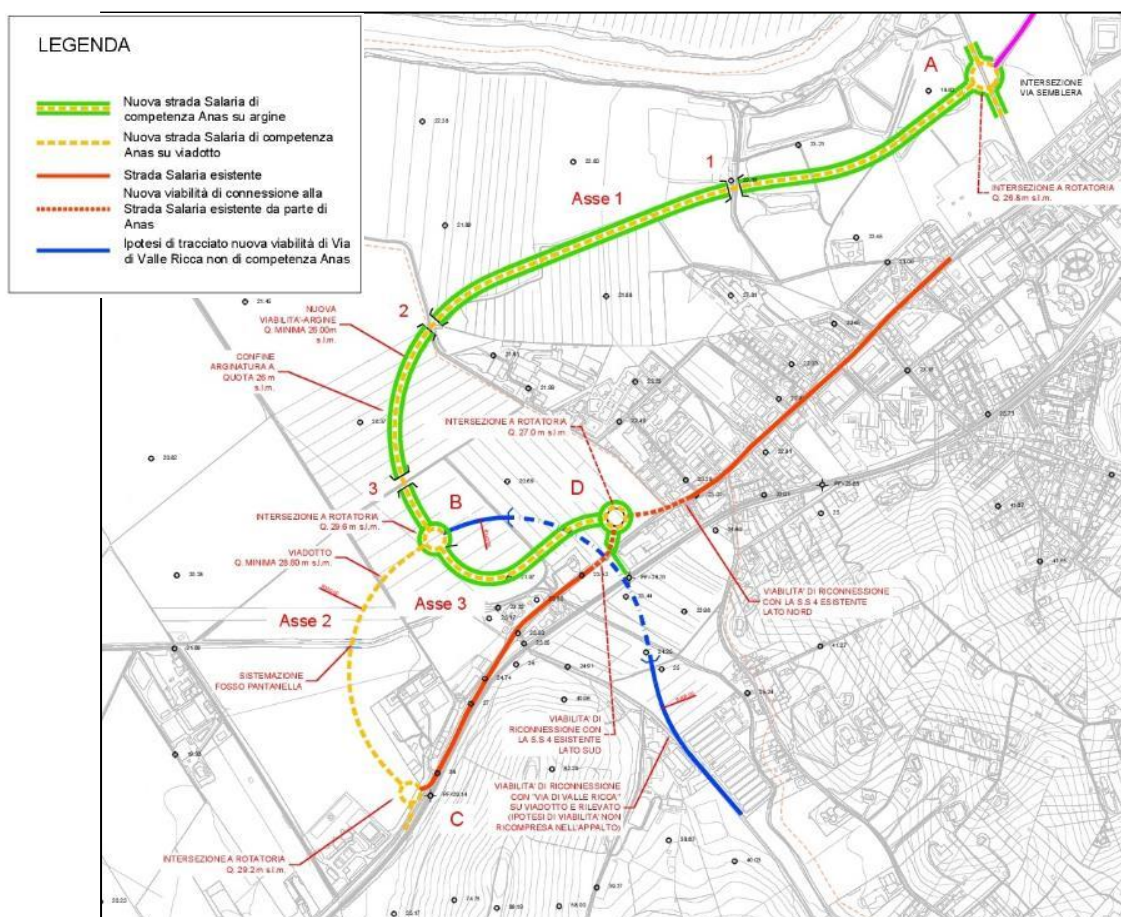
Soluzione alternativa 2 di progetto: Planimetria
